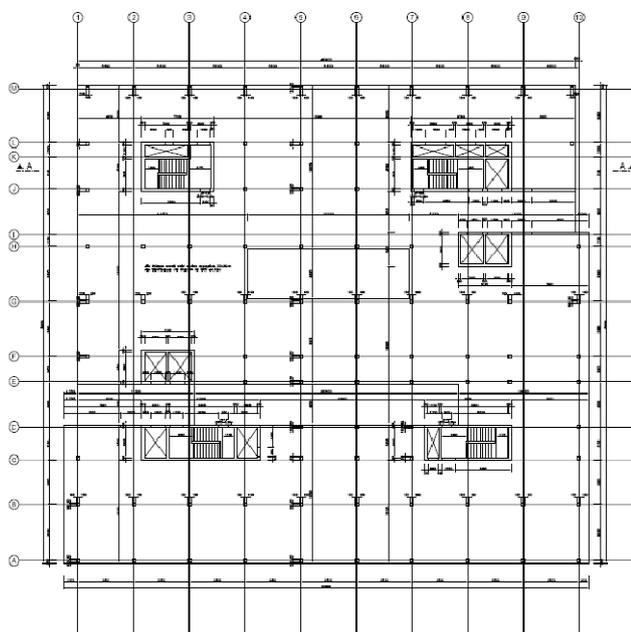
Grundriss – Regelgeschoss (Doka [1])
